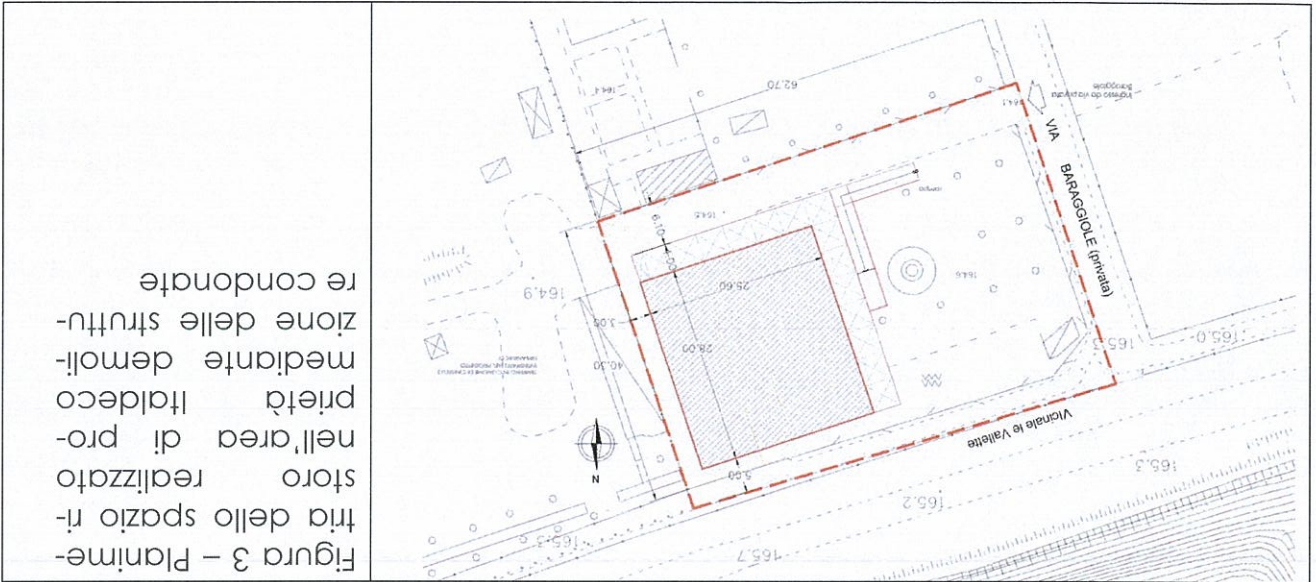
Planimetria dello spazio ristorante realizzato nell'area di proprietà Italdeco mediante demolizione delle strutture condonate
